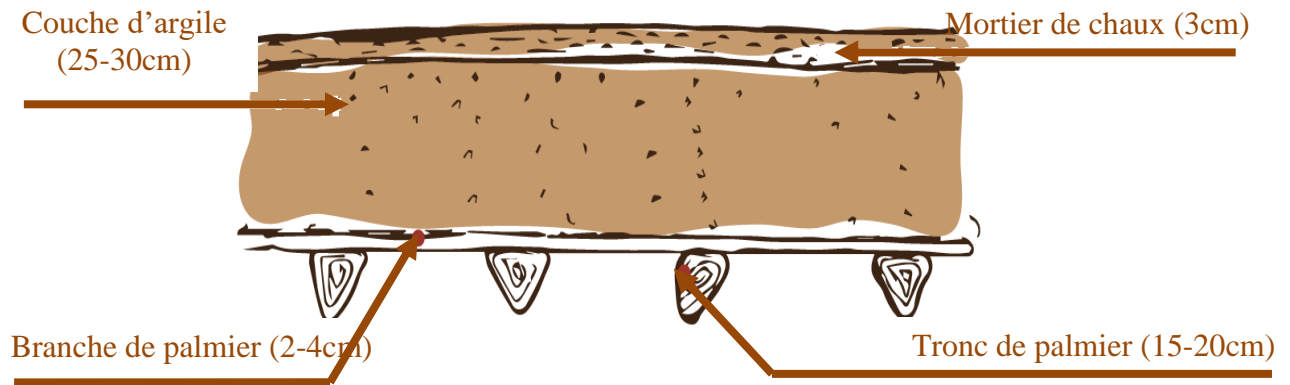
Coupe sur un toit en palmes et argile (OPVM, 2013)
